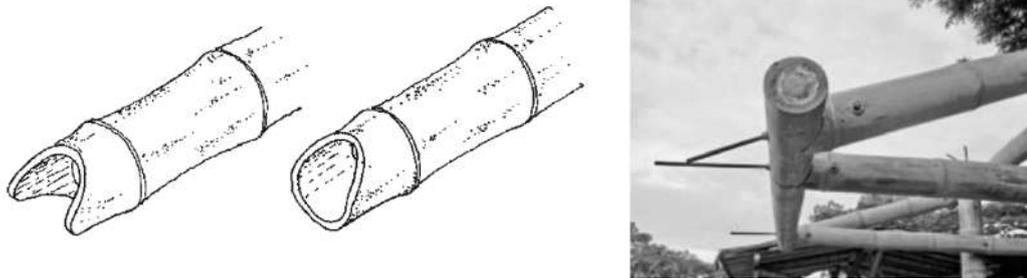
Assemblage en gueule de poisson (croquis et photo, *Building with Bamboo*, Gernot Minke)
